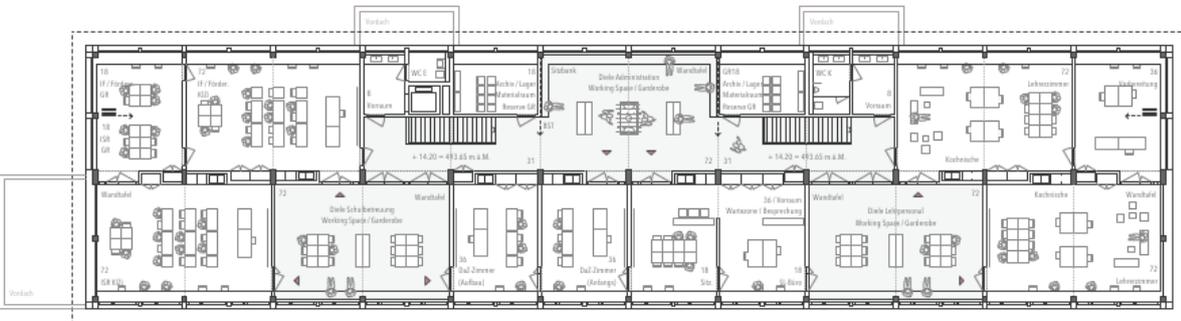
Neubau Sekundarschule, Grundriss 4. Obergeschoss
